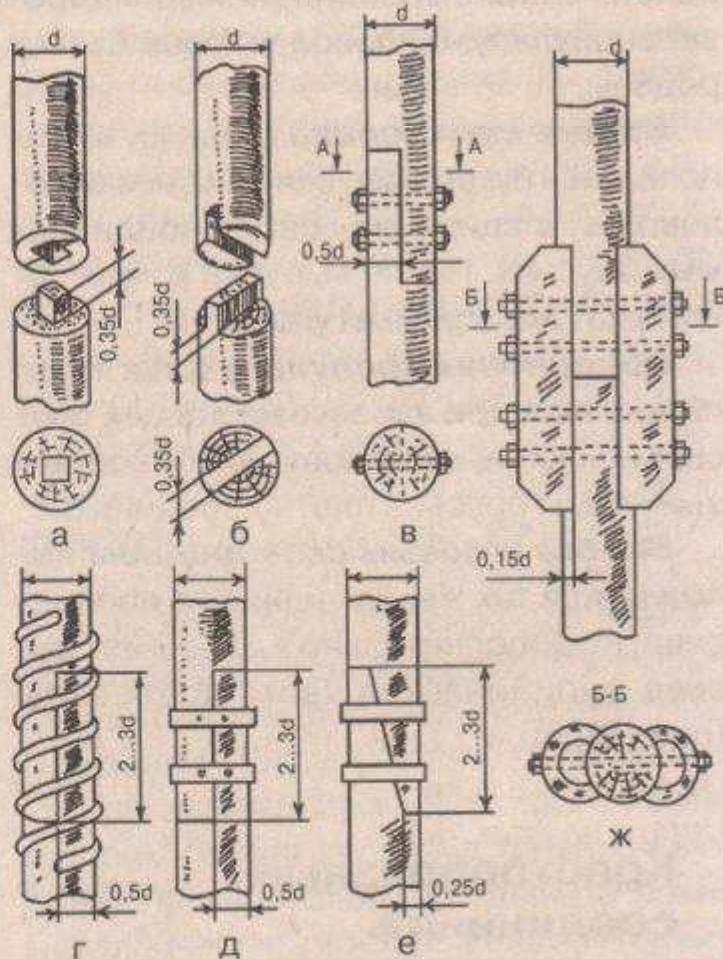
Соединение бревен при наращивании: а — впритык с потайным шипом; б — впритык со сквозным гребнем; в — вплодерева с креплением болтами; г — вплодерева с креплением полосовой сталью; д — вплодерева с креплением хомутами; е — косым прирубом с креплением хомутами; ж — впритык с накладками и креплением болтами
